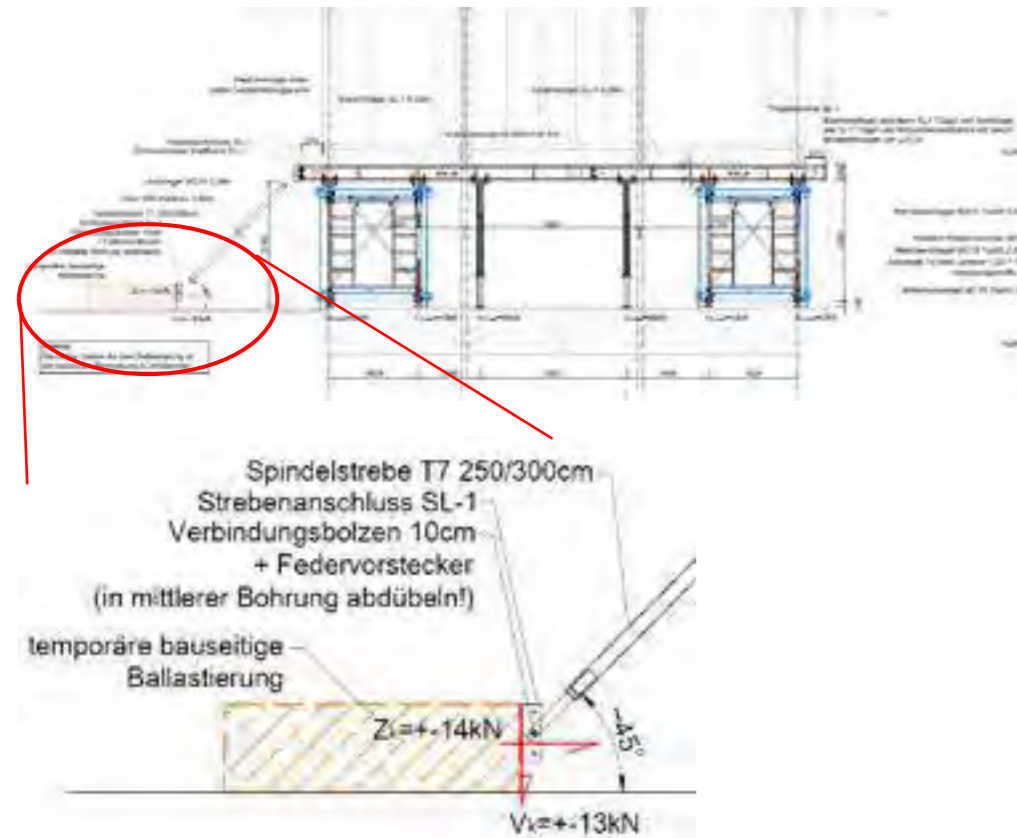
Screenshot aus dem Plan 224-016371-1001.pdf
